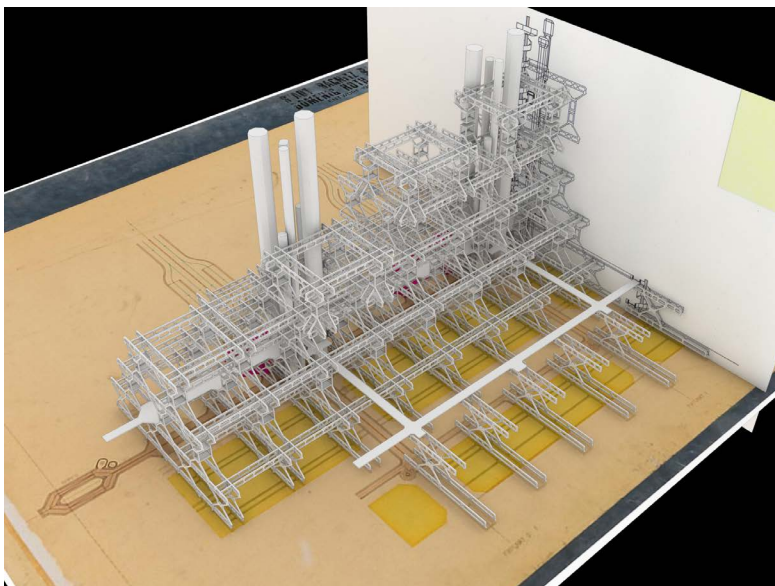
erstes Modell der Tragstruktur mit Schnitt und Ansicht
